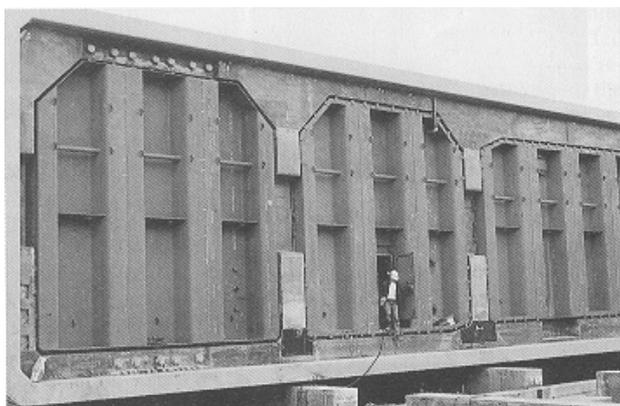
Schottwände (temporär) zum Einschwimmen einer Tunnelröhre
